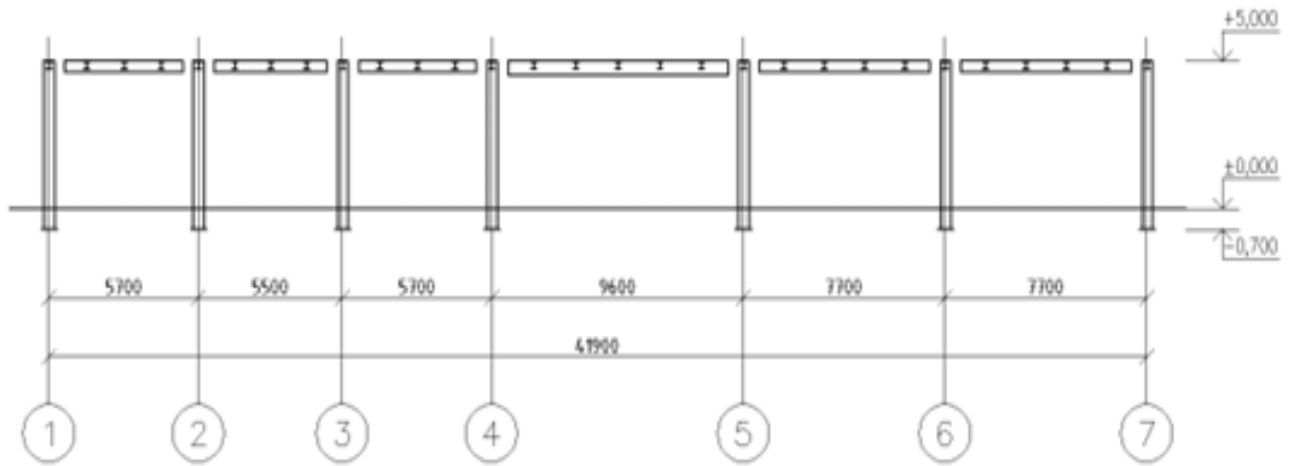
Подовжня розрахункова рама будівлі
